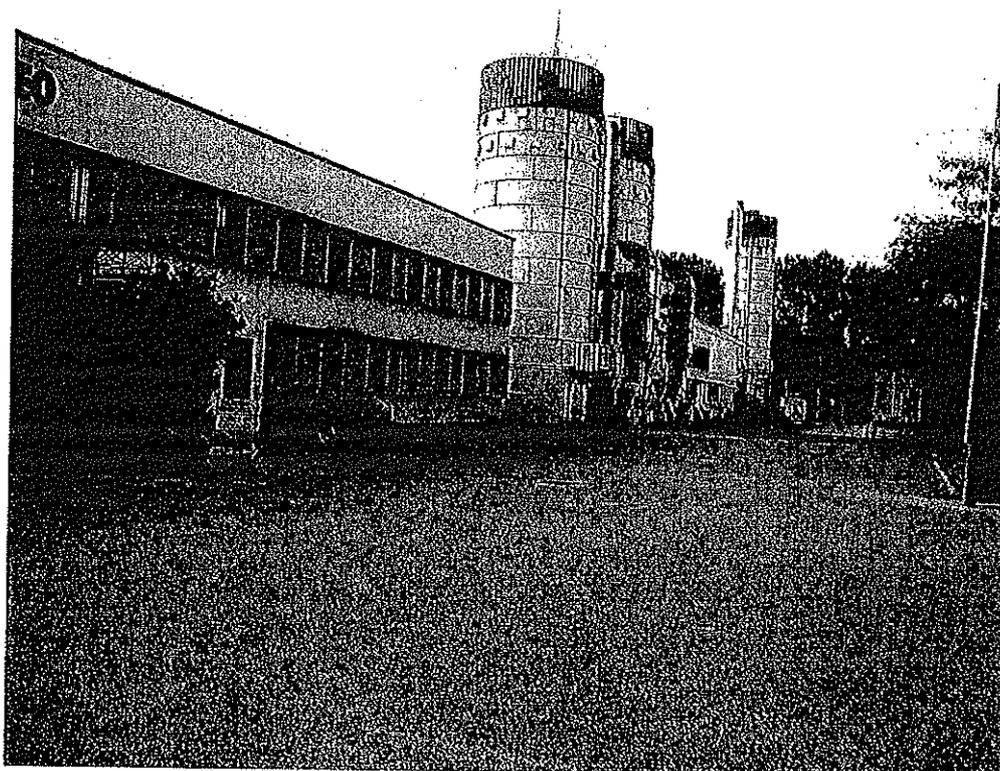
Corpo uffici nel fronte Ovest, lato Sud.
